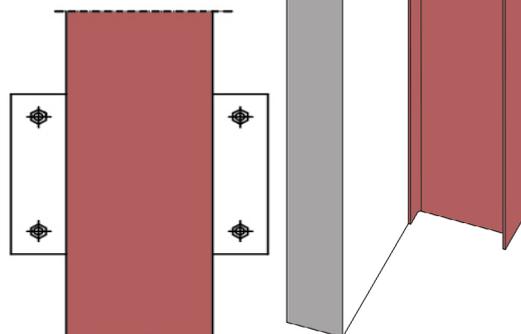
schema disposizione degli elementi strutturali, porzione del vano centrale lato Est.
